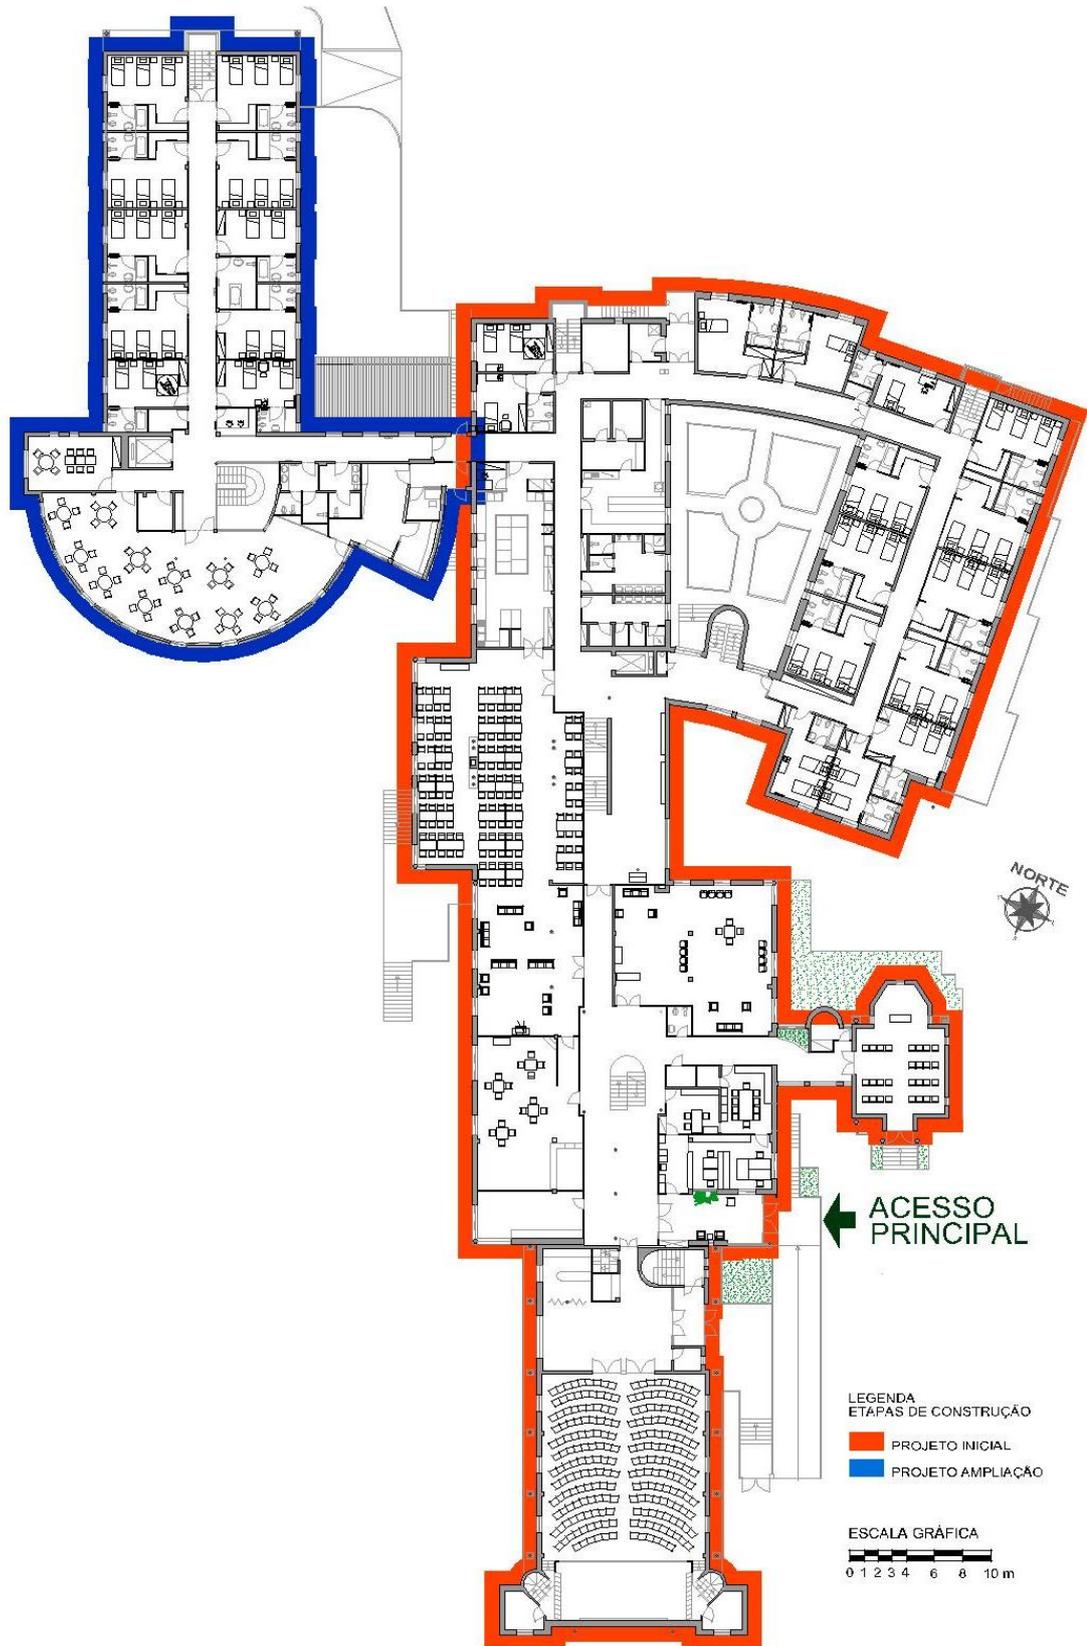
ILPI 1 - Planta Baixa Geral - 2º pavimento.
